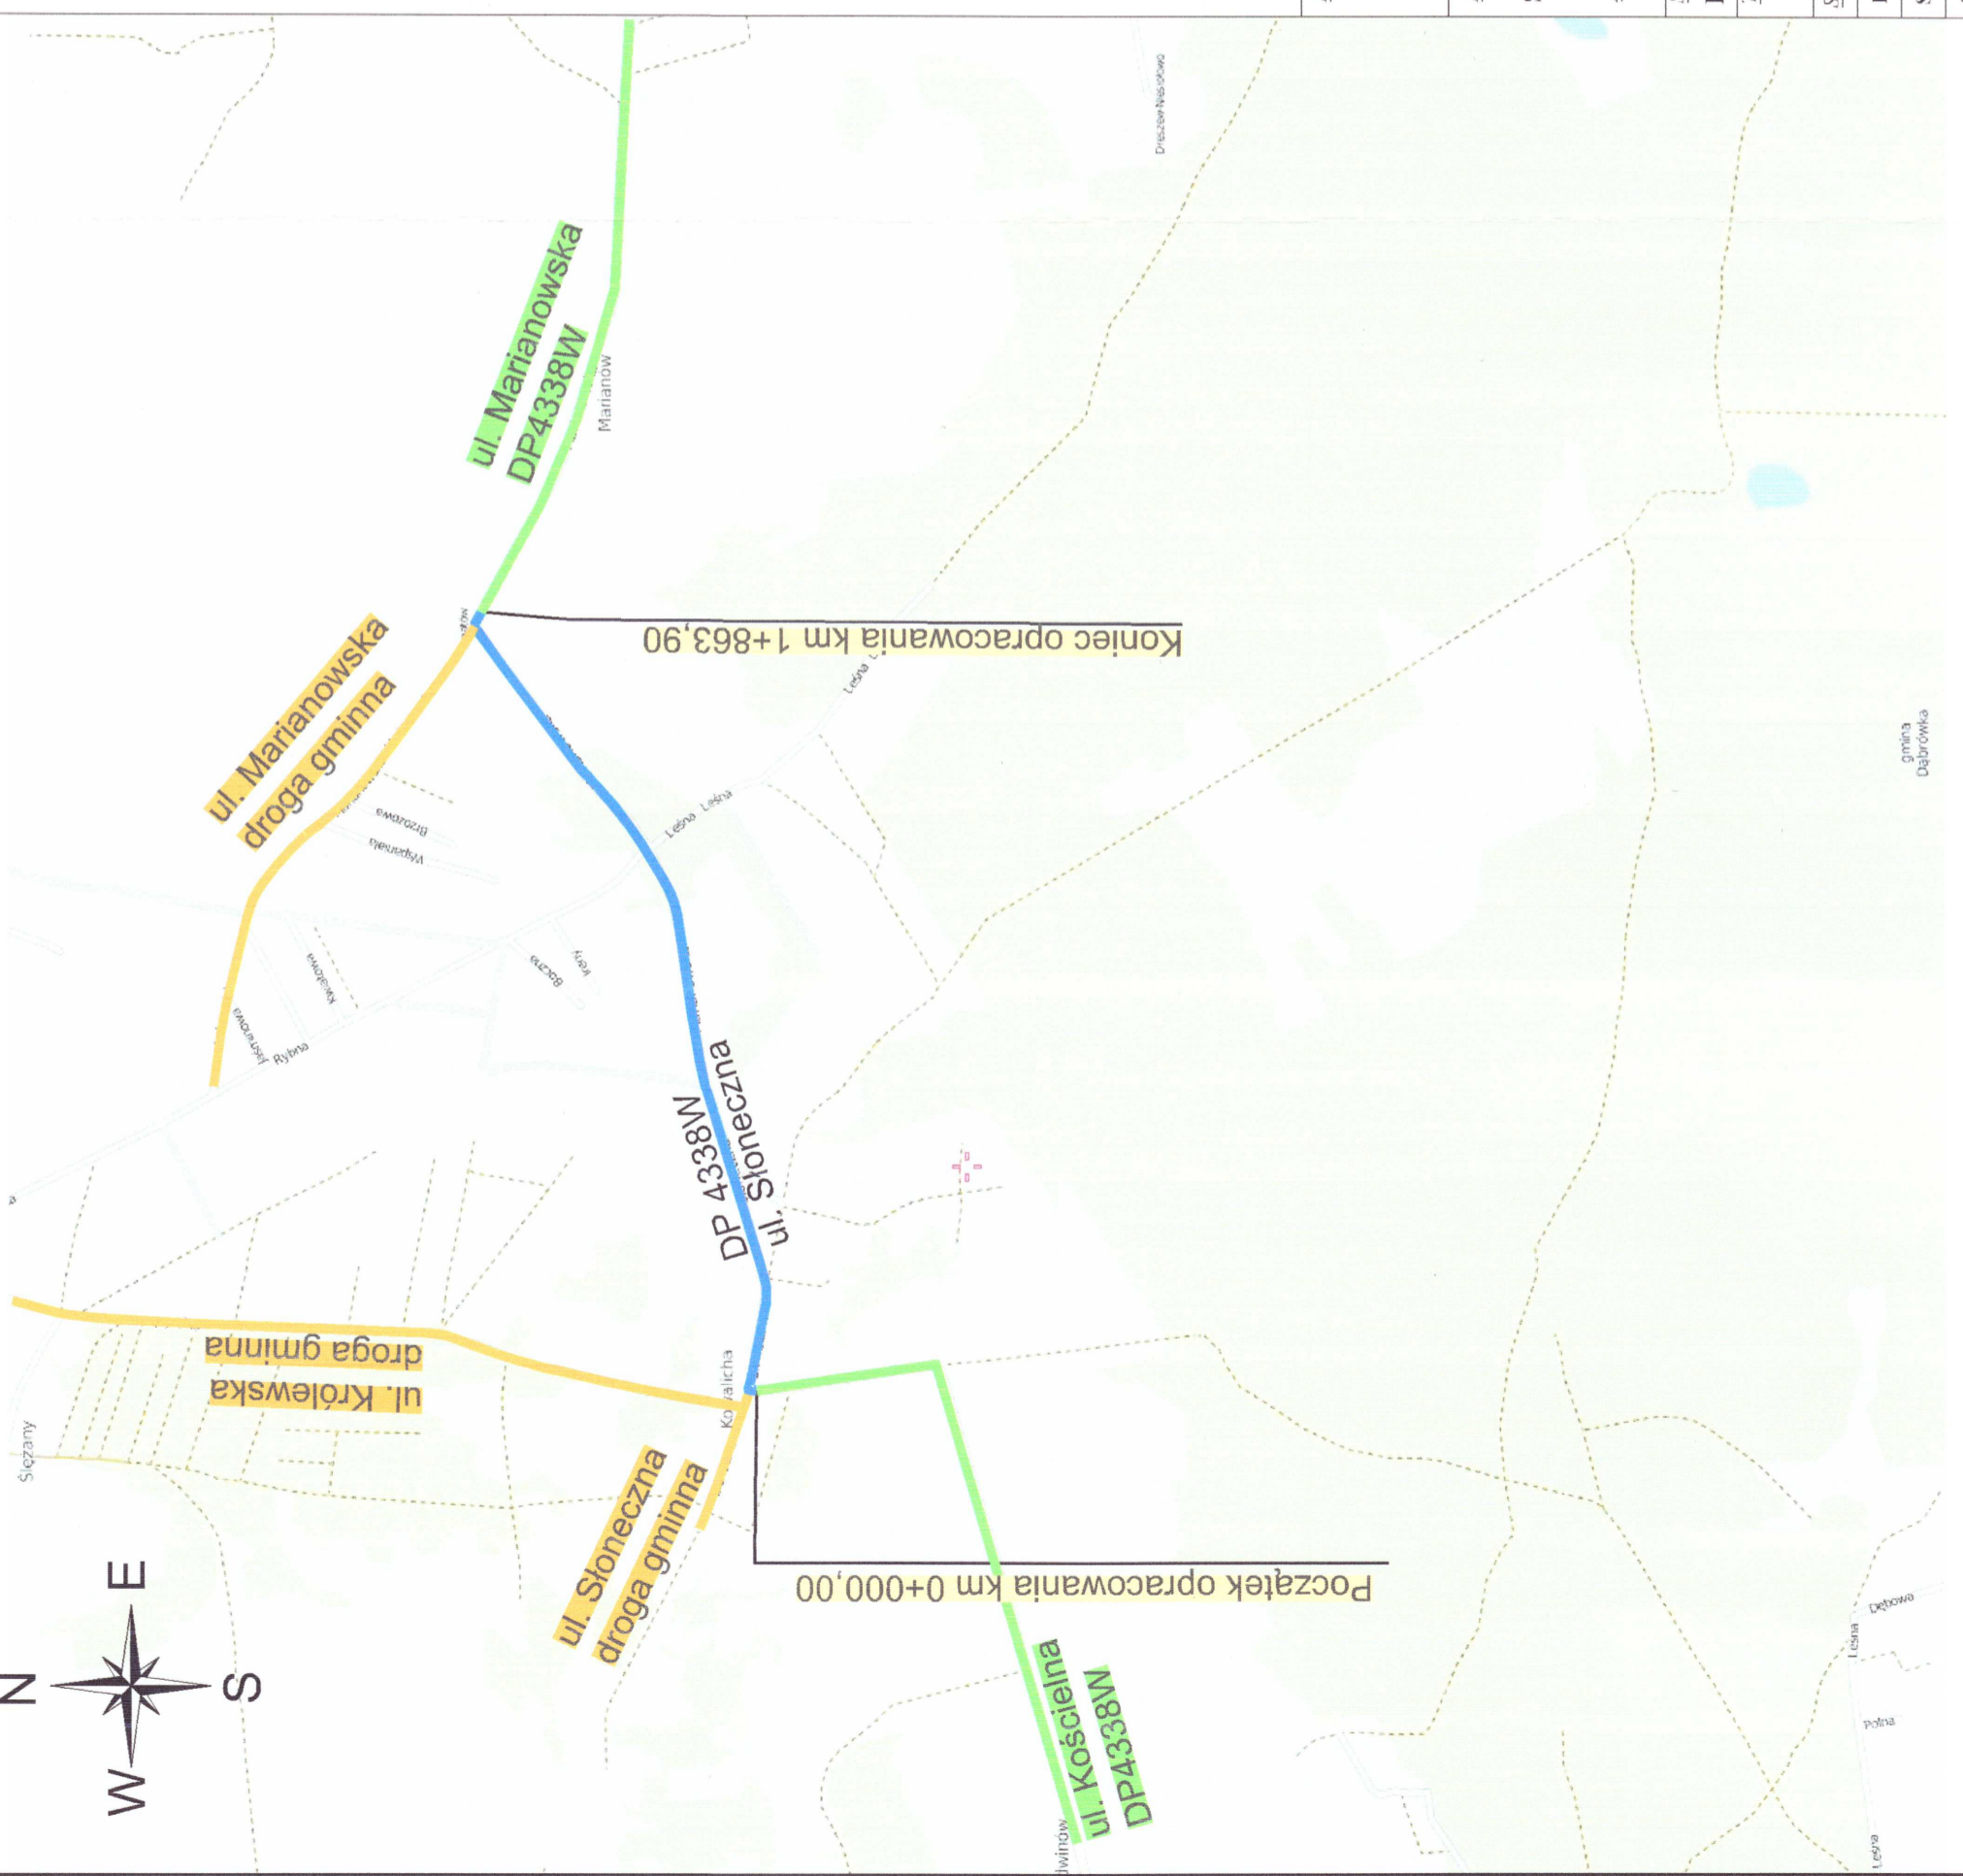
Plan sytuacyjny w skali 1:500
